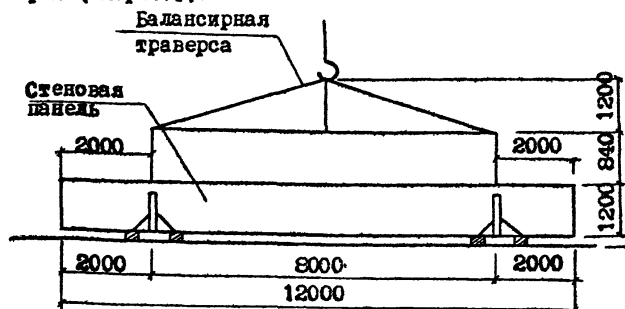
Строповка стеновой панели при разгрузке и монтаже.
